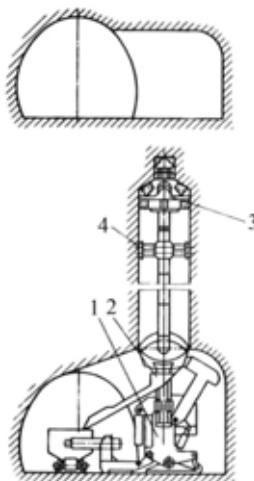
Комбайн 1КВ-1: 1 – комбайн; 2 – шламоуловлювальний пристрій; 3 – робочий інструмент; 4 – опорний ліхтар
